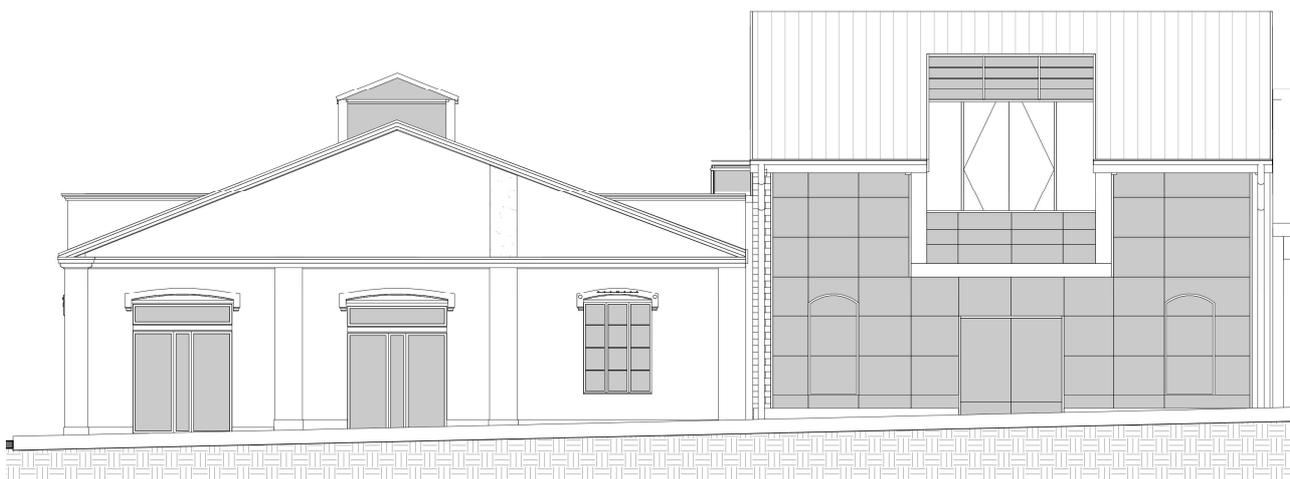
Prospetto Est (Tav. n° 8 scala 1:100)
